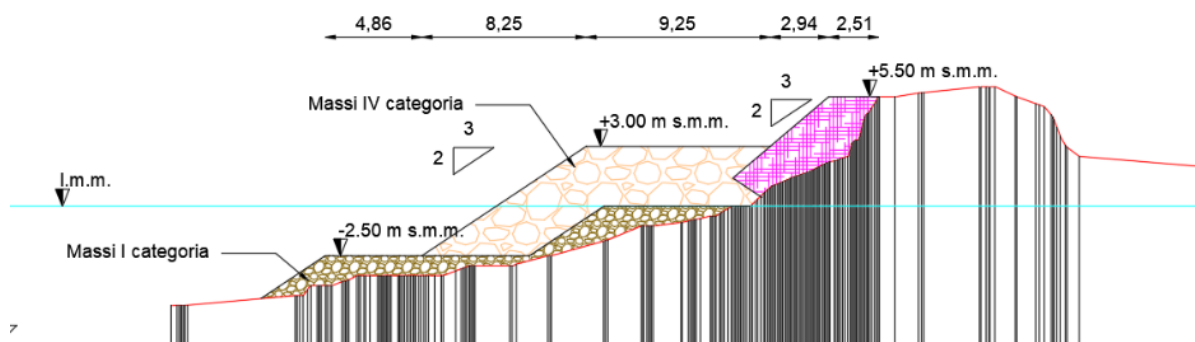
Sezione tipo del tratto compreso fra la sezione 5 e la sezione 7
